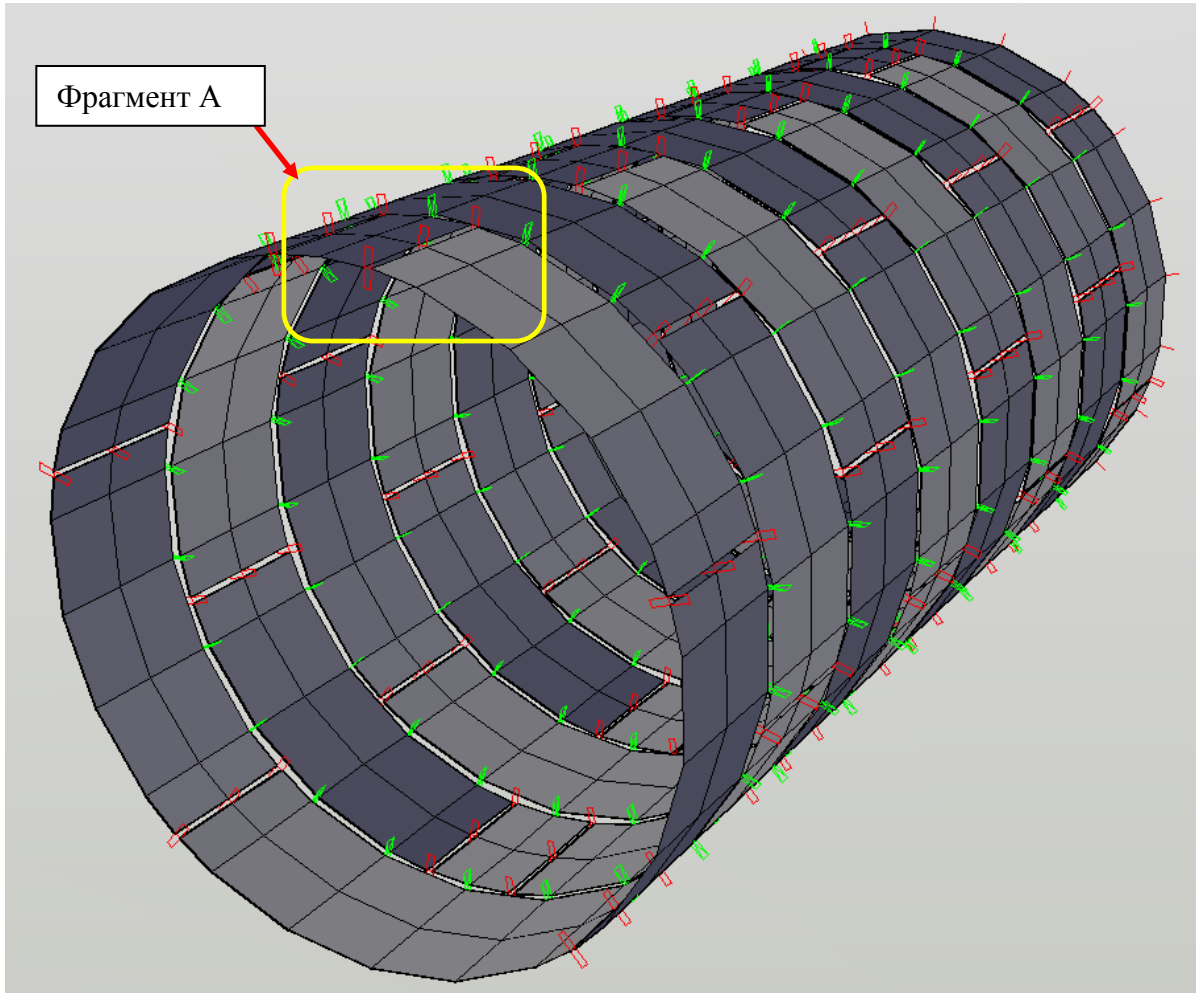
Общий вид расчётной схемы сборной железобетонной тоннельной обделки.
